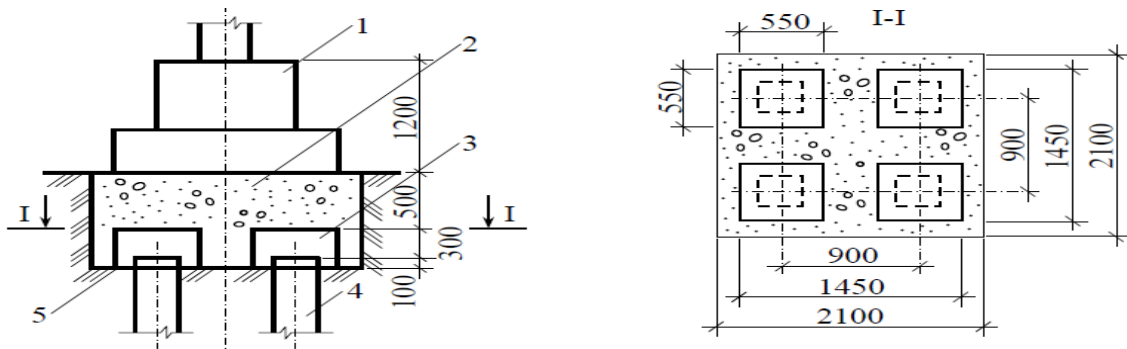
Пальовий фундамент із проміжною подушкою: 1 – фундаментний блок; 2 – проміжна подушка; 3 – залізобетонний оголовок; 4 – залізобетонна паля; 5 – дно котловану
